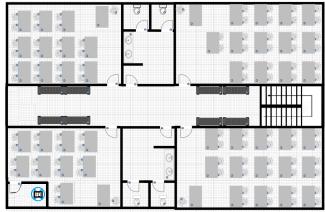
Planta do Primeiro Andar do Edifício  $4\,$
